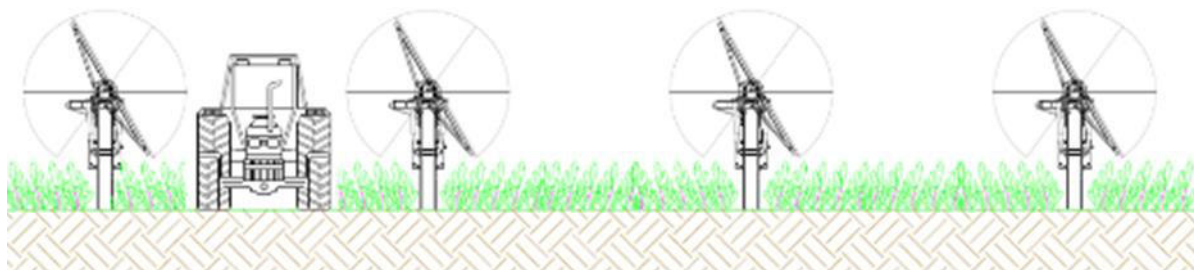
Particolare dello stato di progetto: distanza tra i tracker e transito dei mezzi meccanici (sezione trasversale).
